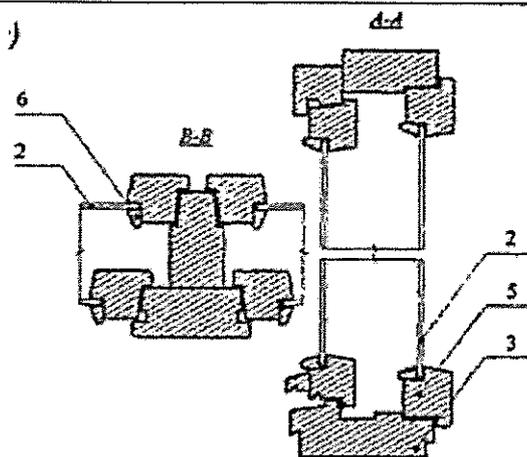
Схема расположения оконных панелей из дерева
